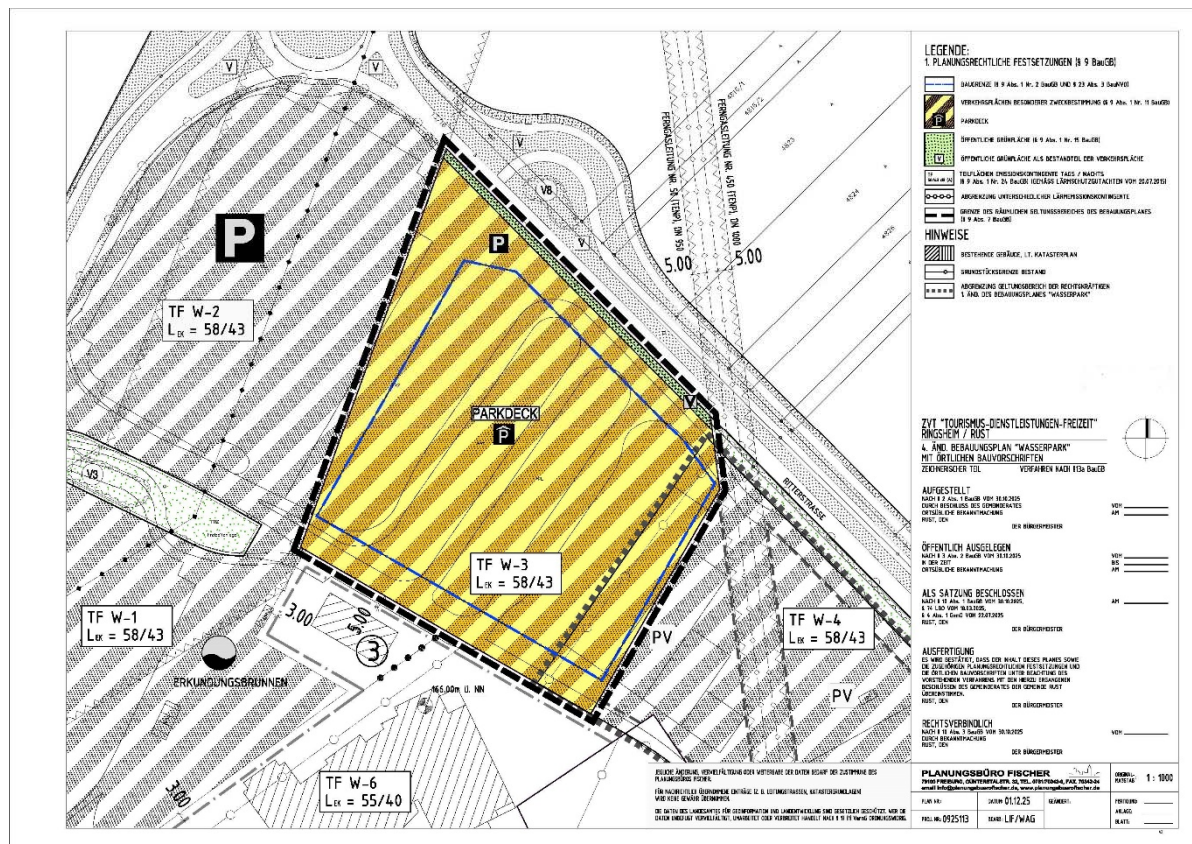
Bebauungsplan (Quelle:Büro Fischer)
